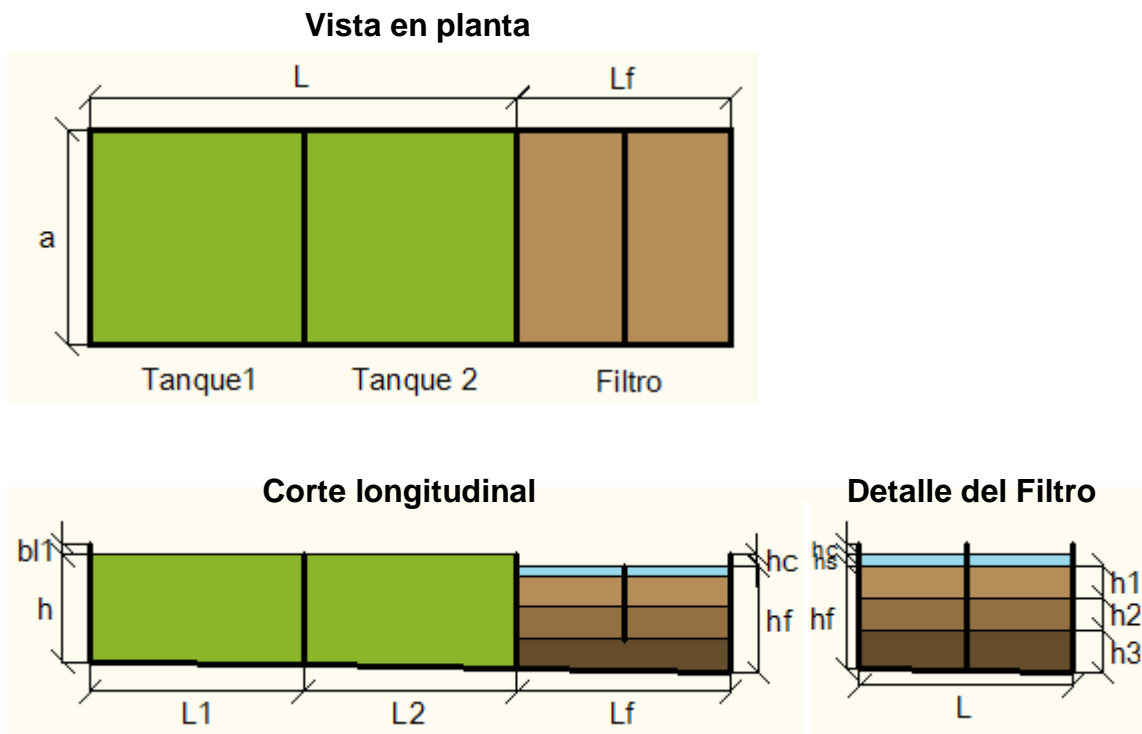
Esquemas vista planta, corte longitudinal y corte transversal de la Alberca Biológica.
